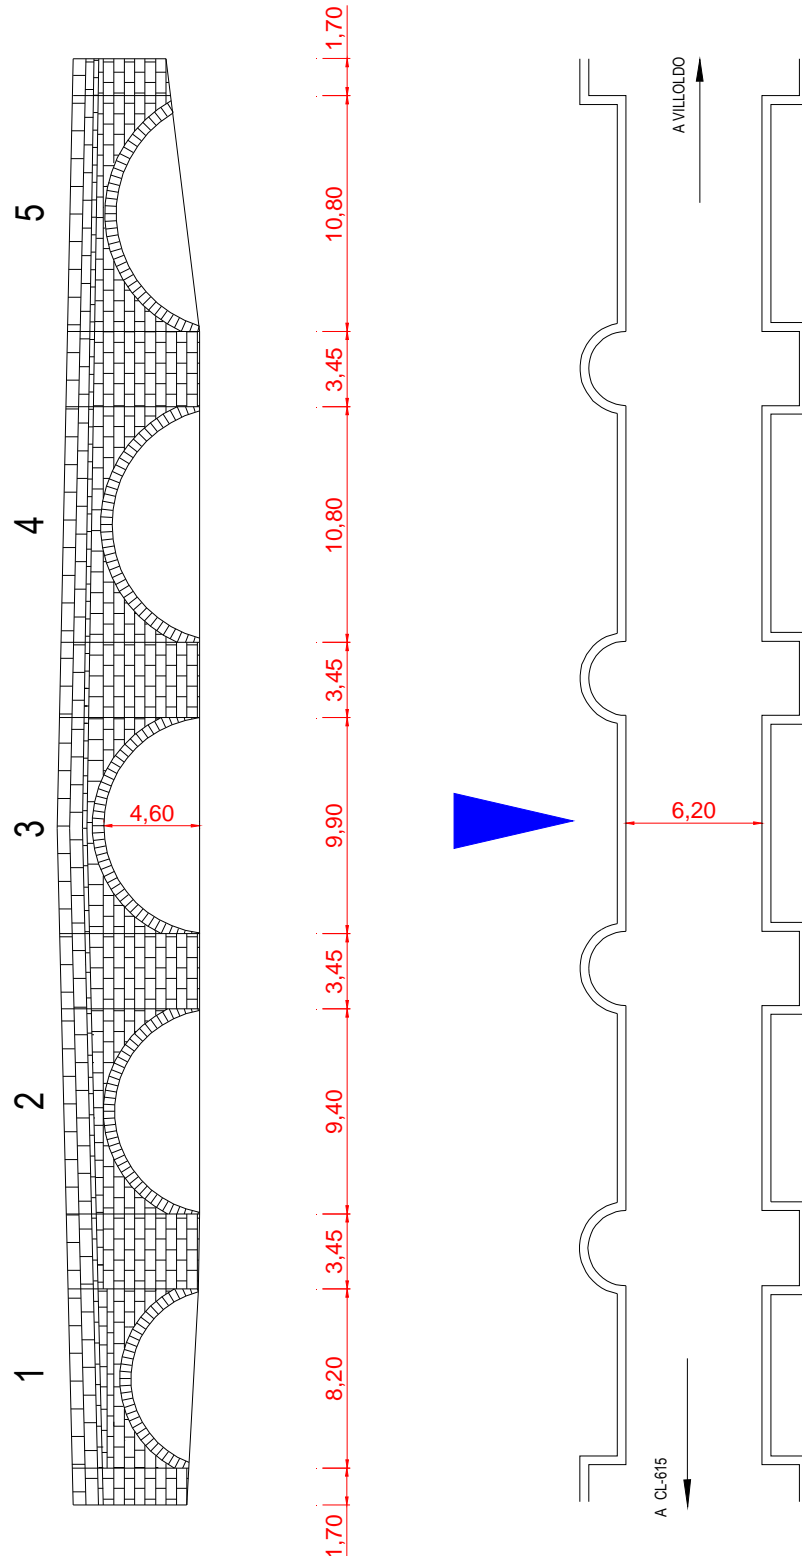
Planta y alzado de aguas abajo del puente en Villodo
